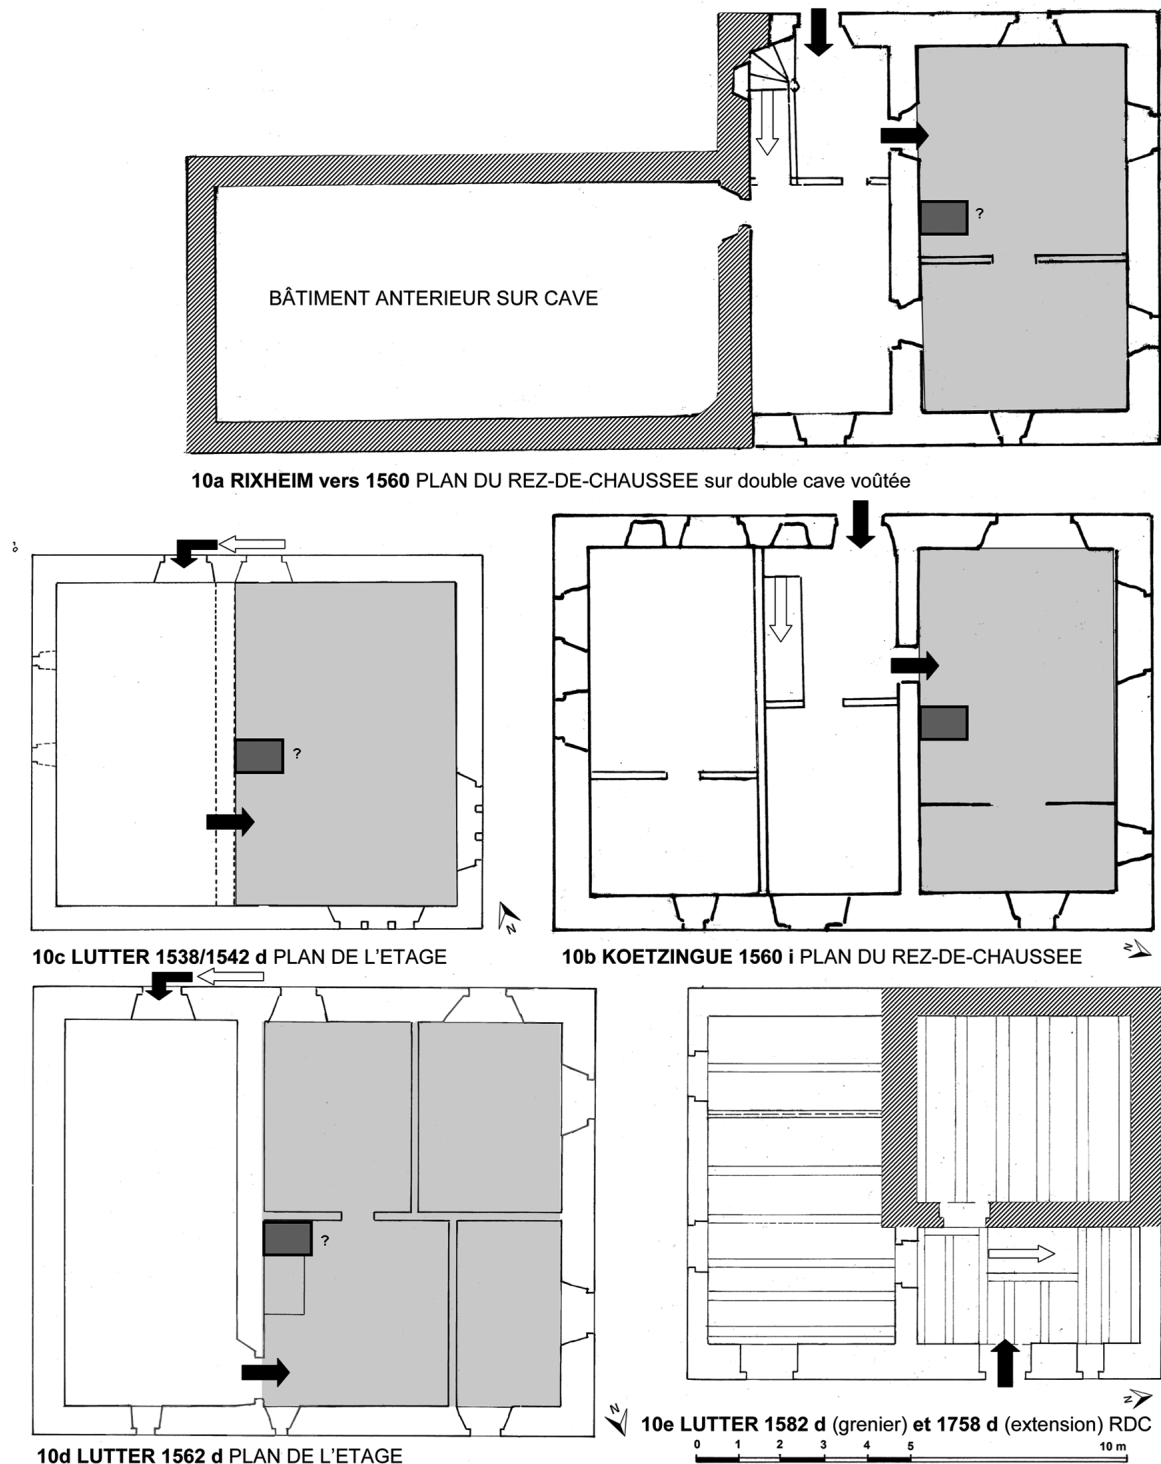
Plans de maisons de pierre dans le Sundgau
